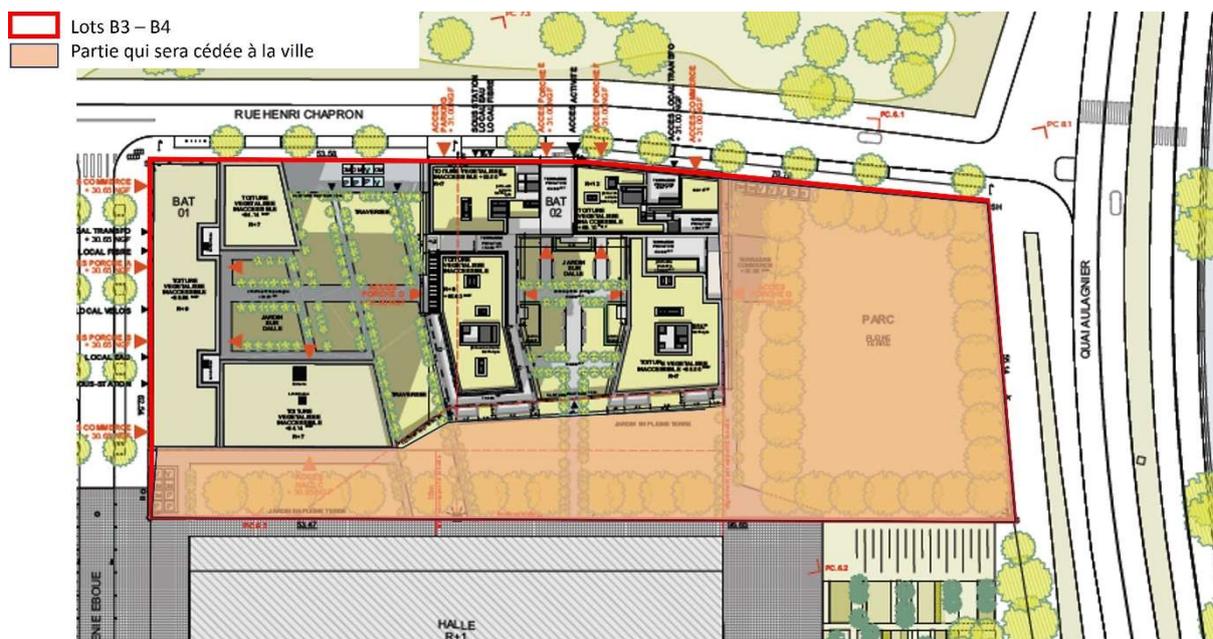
Terrain cédé à la ville – Fond de plan : PPX architectes – 18/12/ 2023
